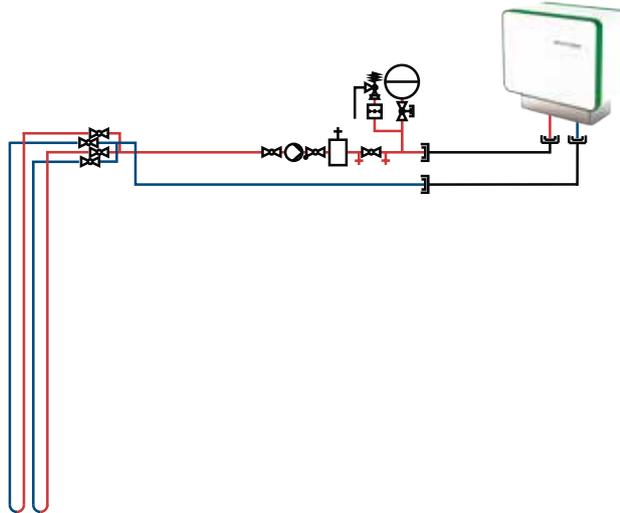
Hydraulik Schema Primärkreis (Solesonde)
